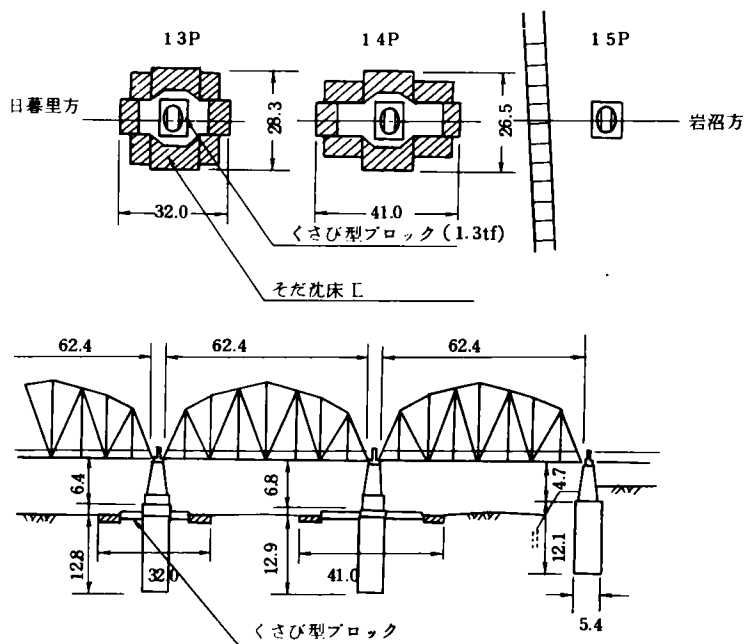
常磐線亘理～岩沼間阿武隈川橋りょう平面図と側面図
